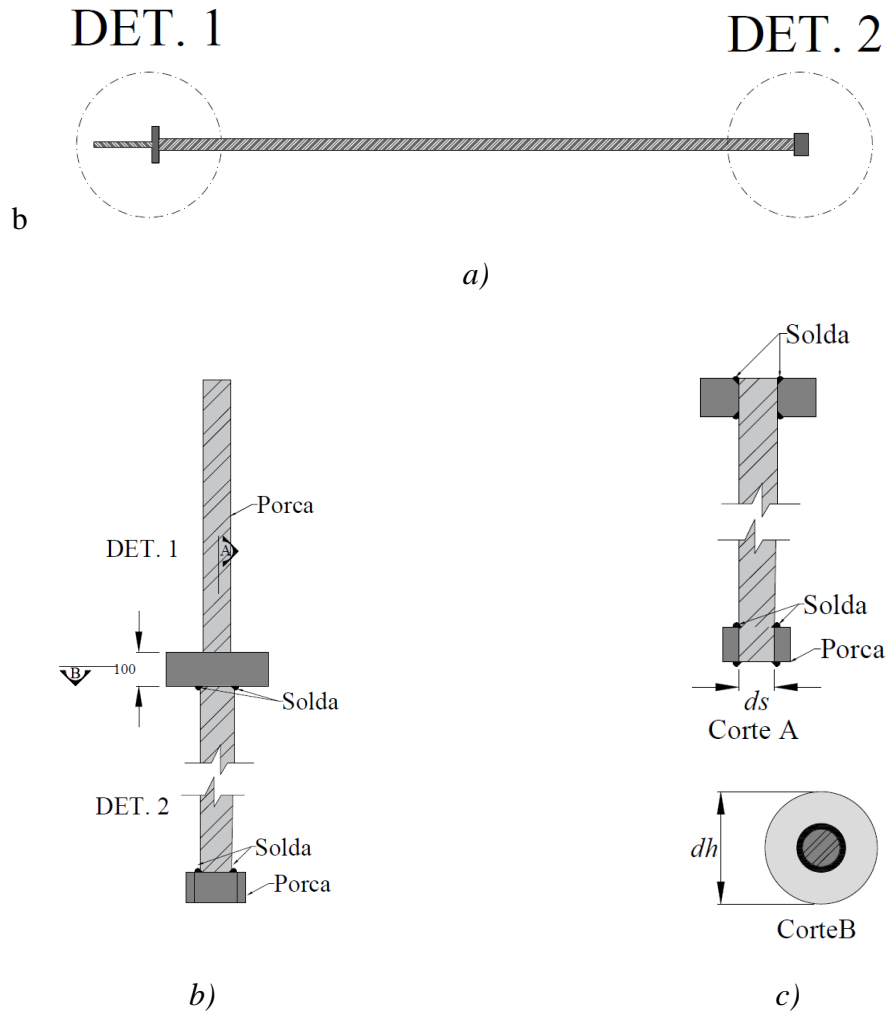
Projeto executivo para soldagem de cabeça e porca na haste do conector *a) Vista do conector; b) Detalhamento da conexão cabeça e porca; c) Cortes A e B
